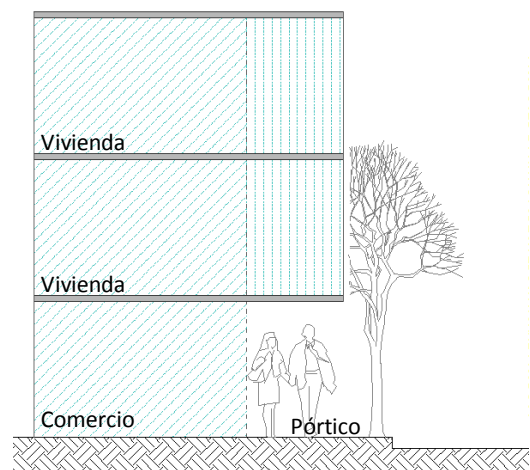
Corte esquemático que indica el uso en planta baja con el paso peatonal, cubierto por portales y la expansión en planta alta.
